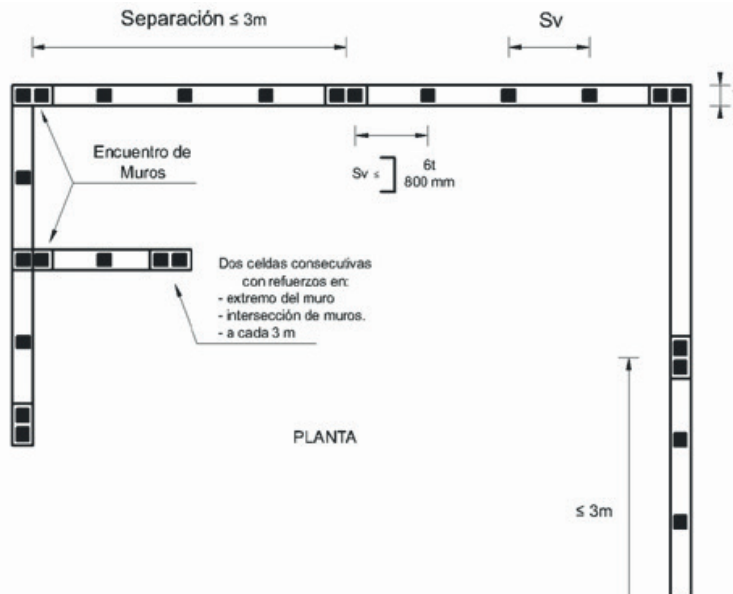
Planta típica de muros reforzados, ubicación del refuerzo vertical.
